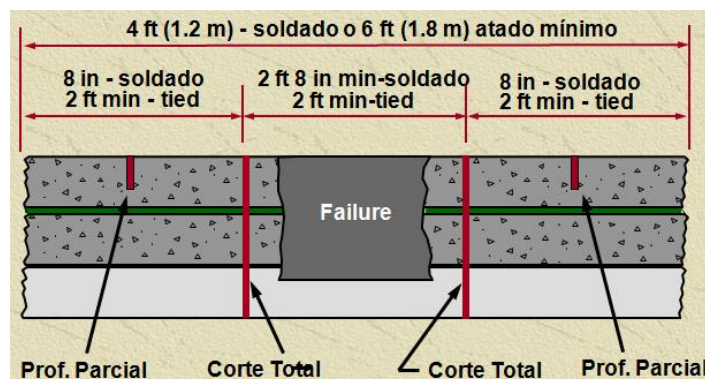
Ubicación de cortes para losas con armadura de refuerzo
